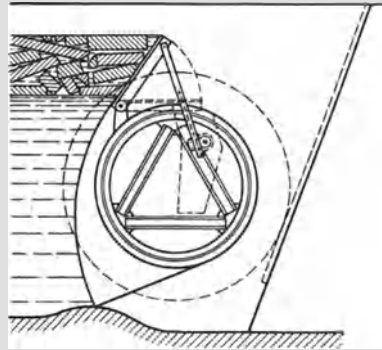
Zylinder mit Stauschild und Eisklappe.
